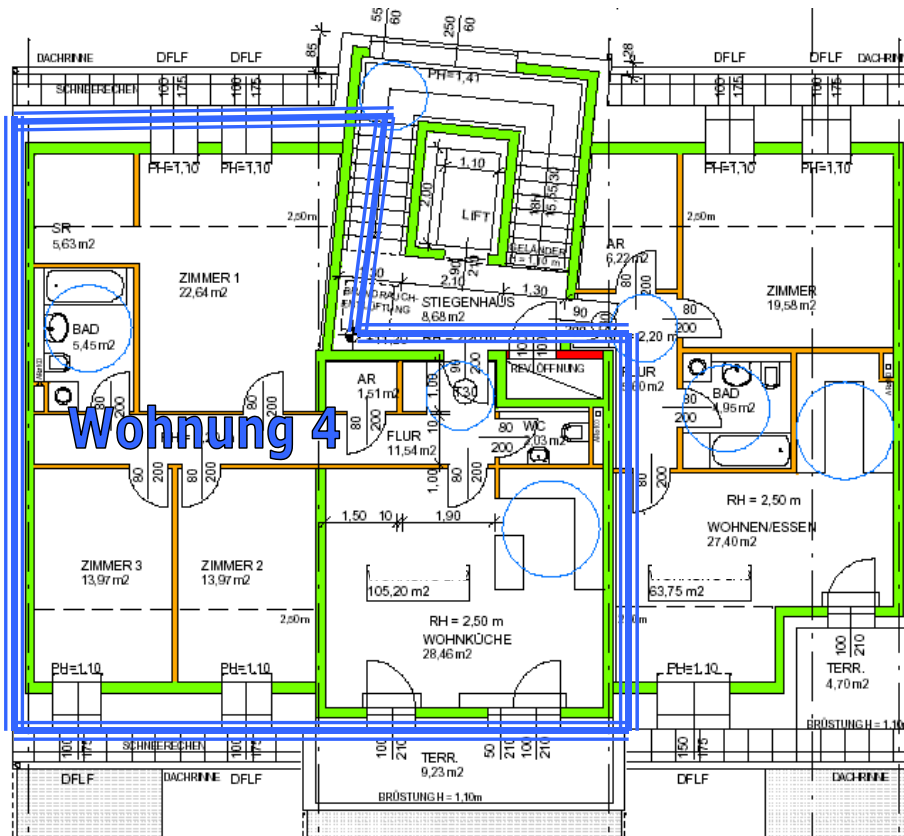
Grundriss Dachgeschoss Haus 2 mit der Lage der 4. Messwohnung [Arch. DI Franz Kuzmich]
